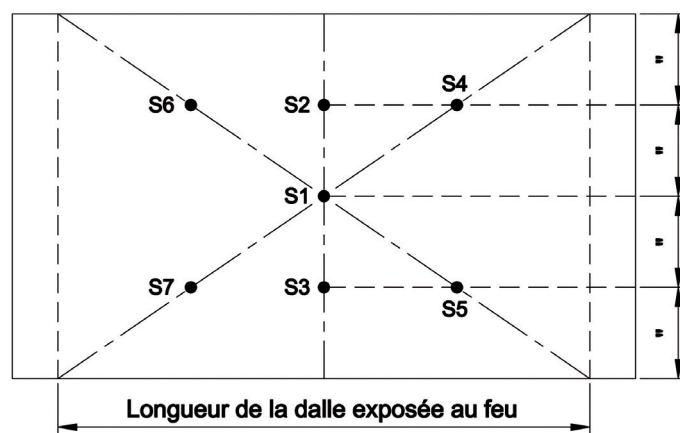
Positions des sections de mesures dans la dalle béton (vue en plan)
